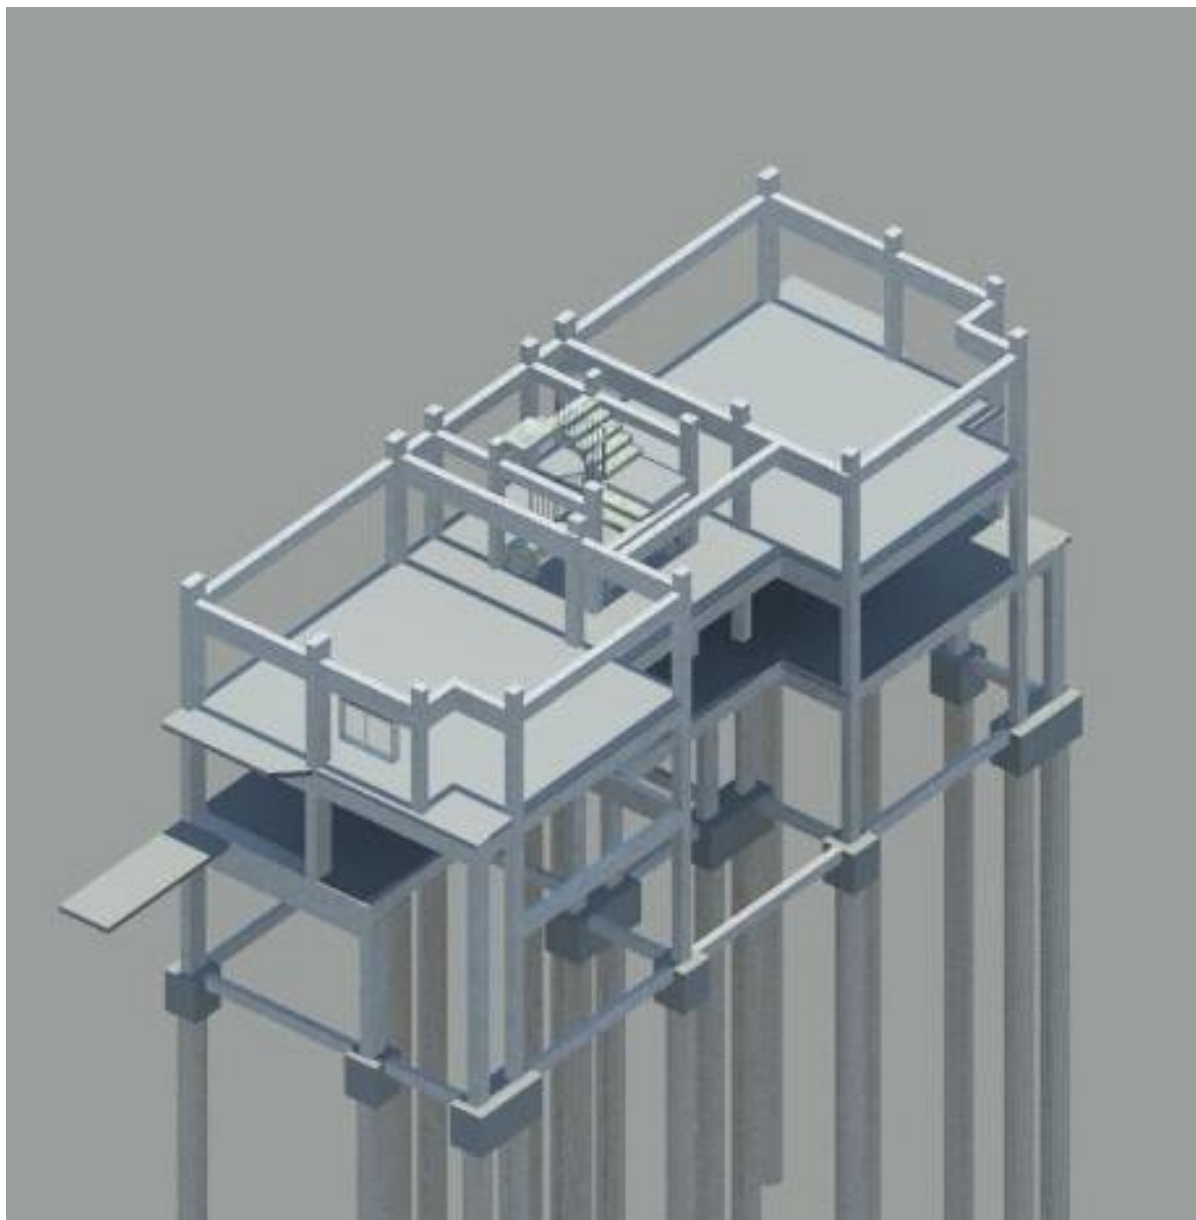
Perspectiva da estrutura do edifício com destaque para as vigas do segundo pavimento
